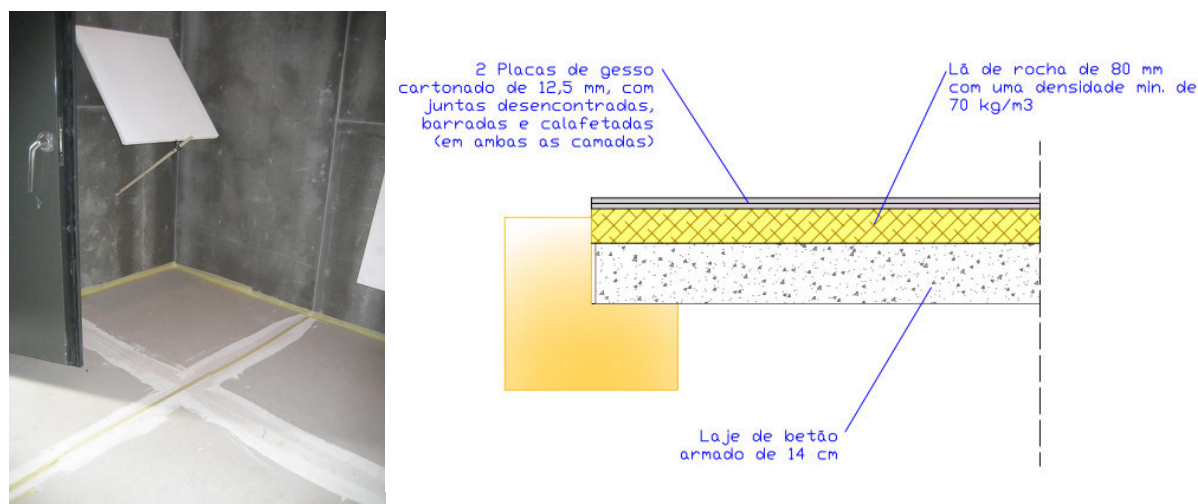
Pavimento pesado tipo C nas câmaras acústicas verticais.
